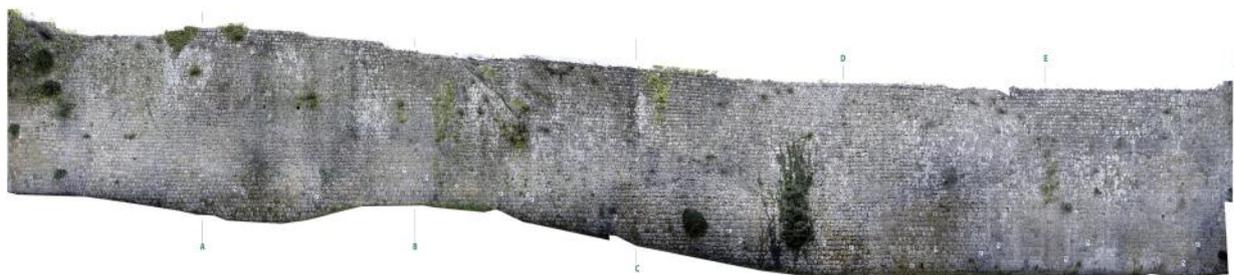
Tratto 2-3/Particolare A – Porzione del paramento murario prima dell'intervento di restauro
